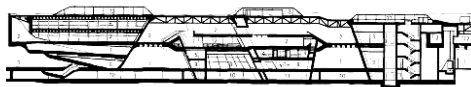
剖面图 (来源: Zaha Hadid 事务所网站 <http://www.zaha-hadid.com>)
